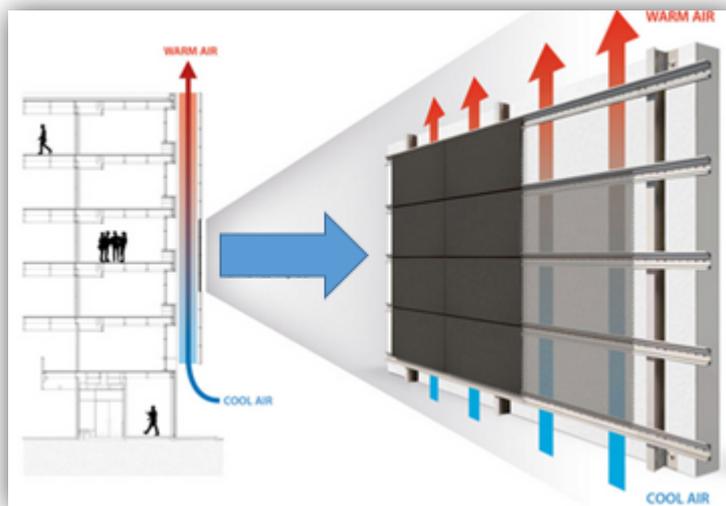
Sistema de una fachada ventilada. (Fuente Tempio)
